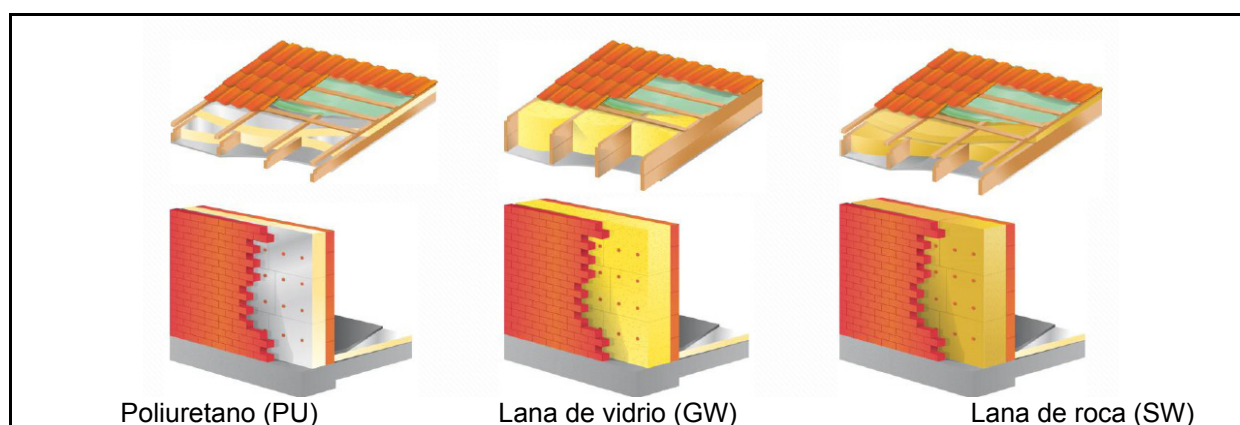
“Soluciones constructivas para aislamiento de cubiertas inclinadas y fachadas con cámara mostrando la relación real de espesor de aislamiento”
